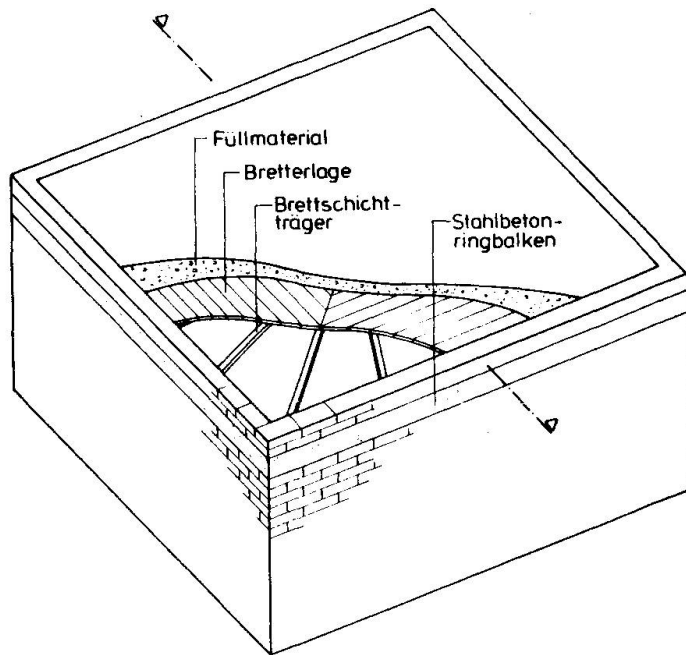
Schematische Darstellung der räumlich gekrümmten Holzbalkendecke mit Stahlbetonringbalken
